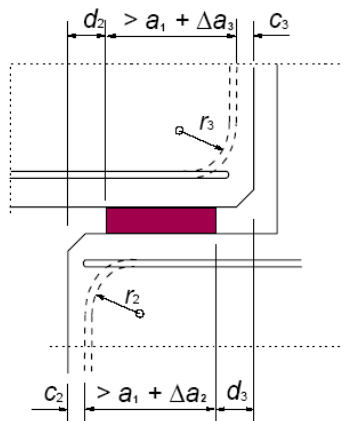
Beispiel der Bewehrungsführung am Auflager
